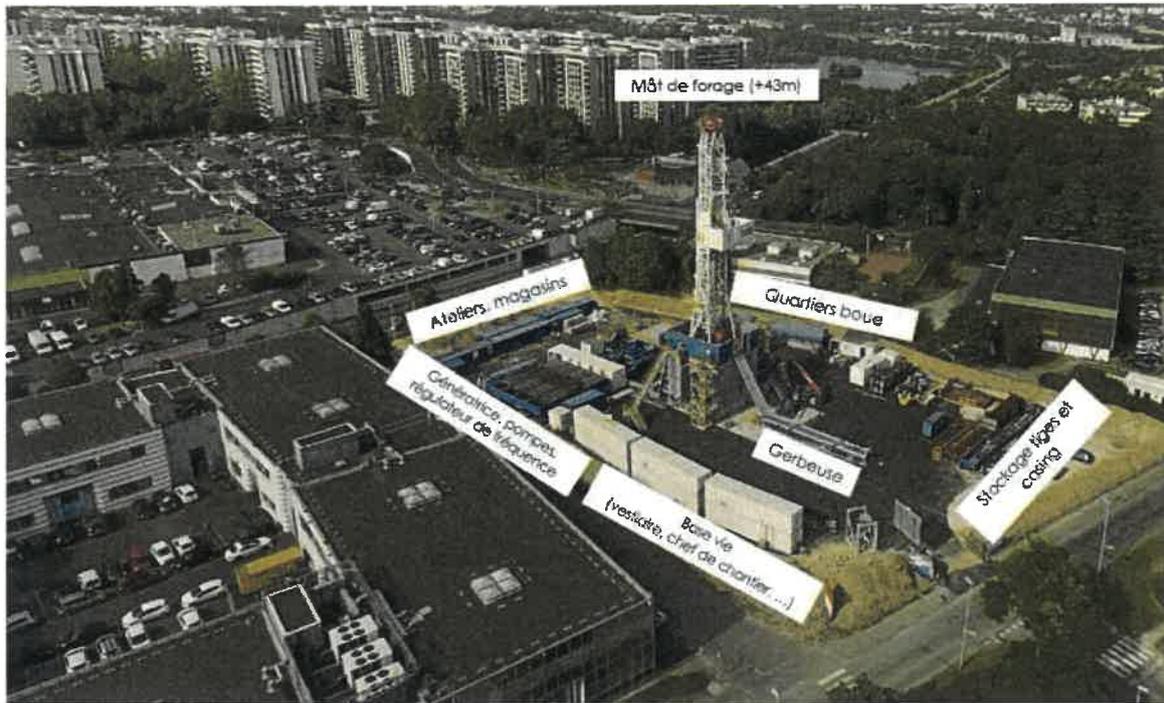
Photo d'un site de forage (Grigny, 2016)
